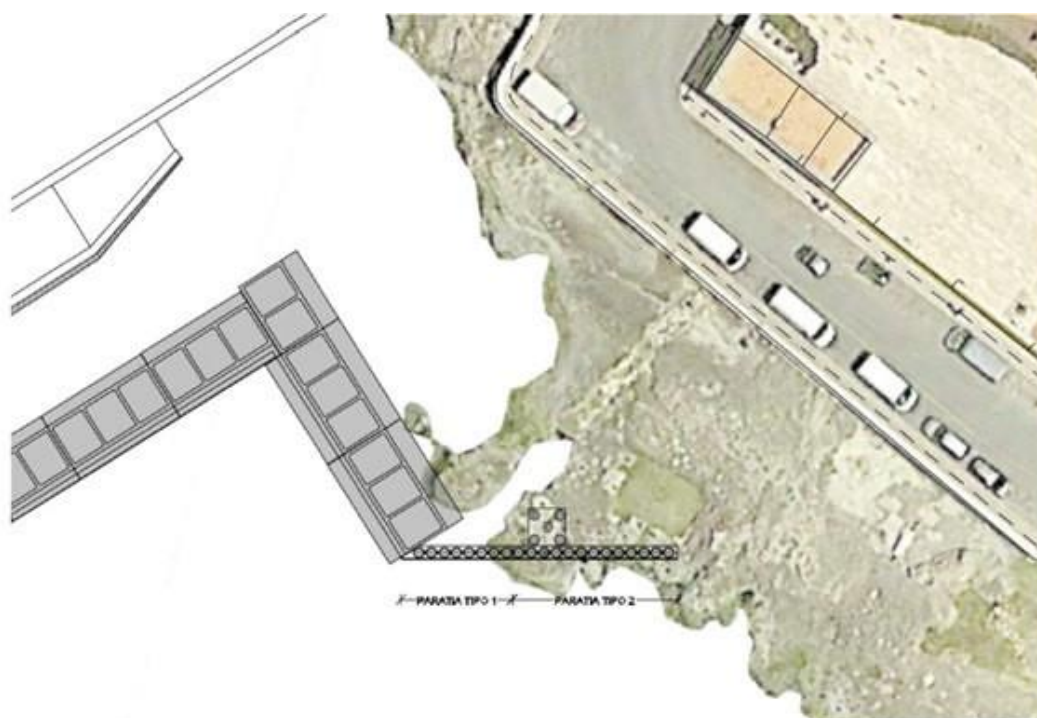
Paratia Tipo 1 e Tipo 2: sovrapposizione planimetria di progetto su ortofoto
